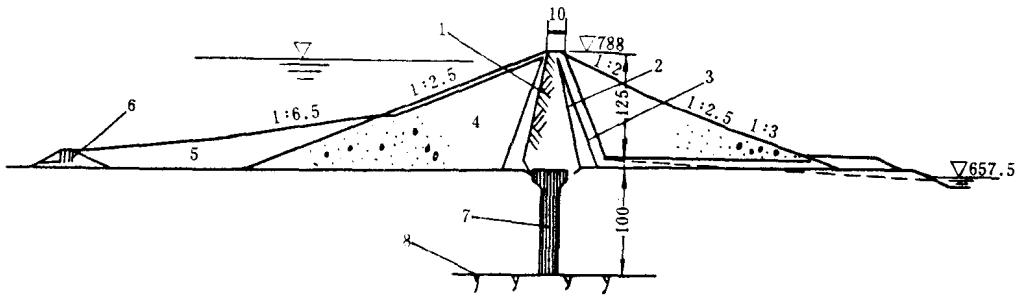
谢尔庞桑坝剖面图 (单位: m)
